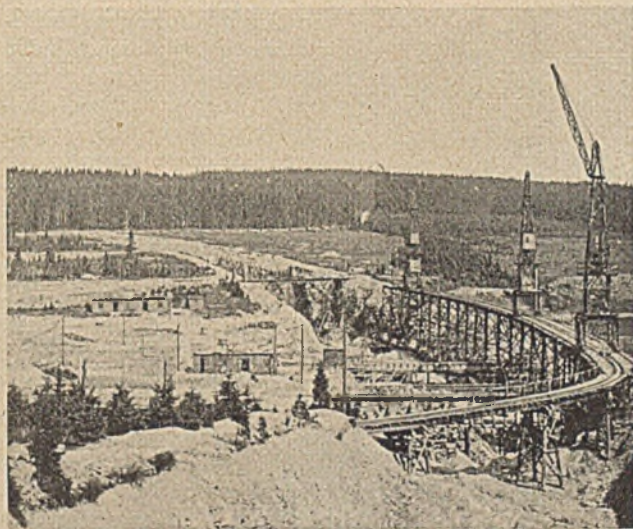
Hauptgerüst mit Turmdrehkränen.
